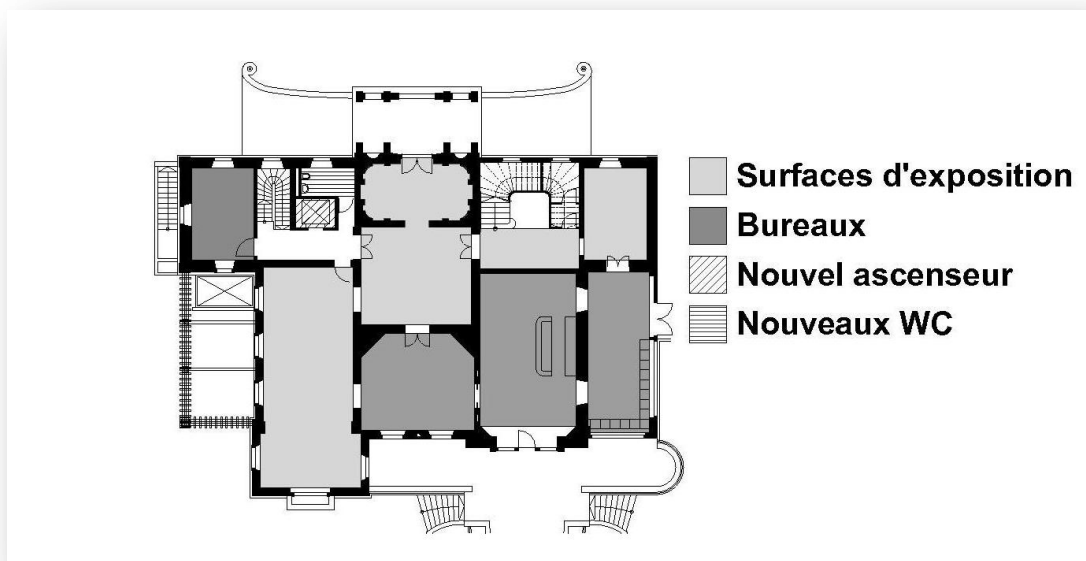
Villa de Pury, rez-de-chaussée: occupation des espaces, *état futur
